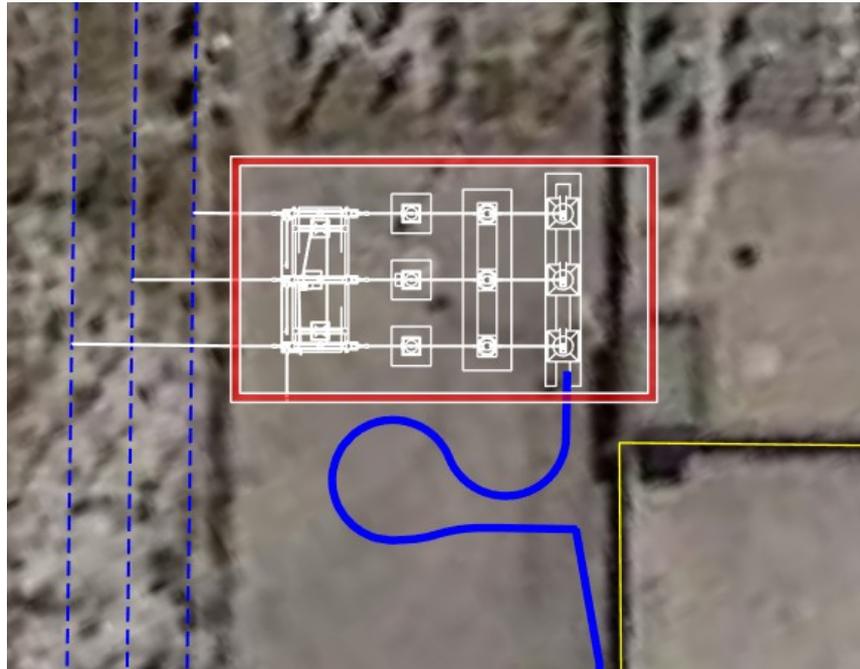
Stralcio planimetrico dello stallo in area Cabina Primaria Enel
